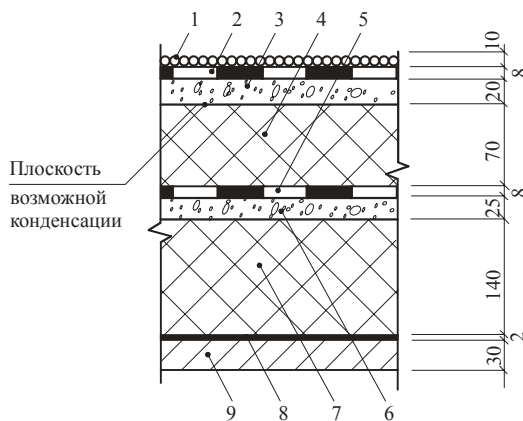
Конструкция покрытия с дополнительным слоем теплоизоляции:
